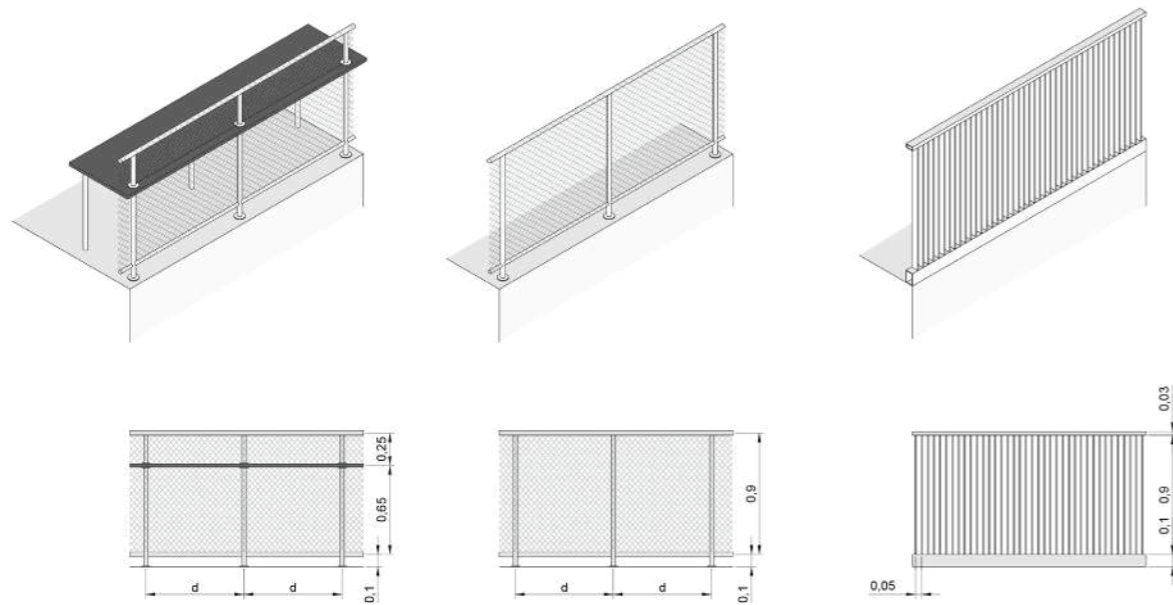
Axonometría detalle barandillas Fuente: elaboración propia
